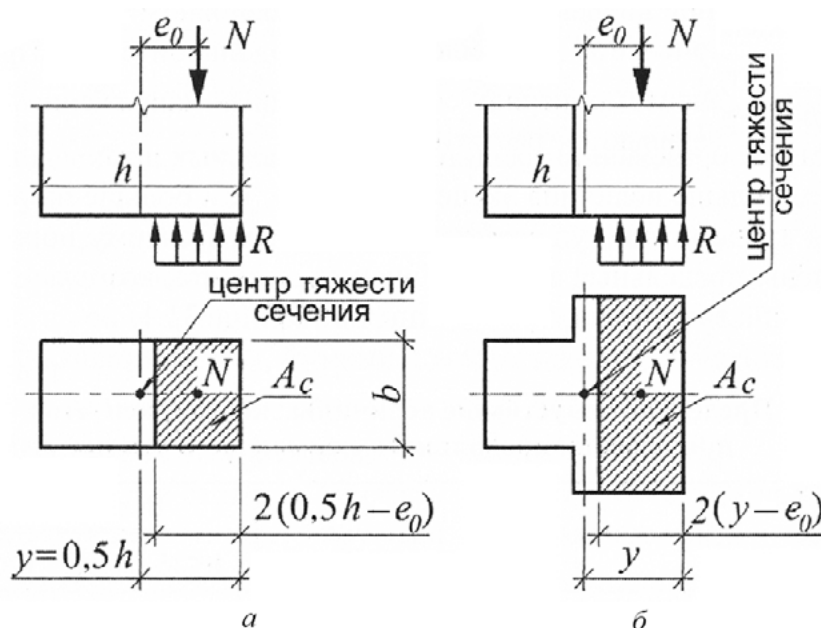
Расчетные схемы элементов прямоугольного (а)
